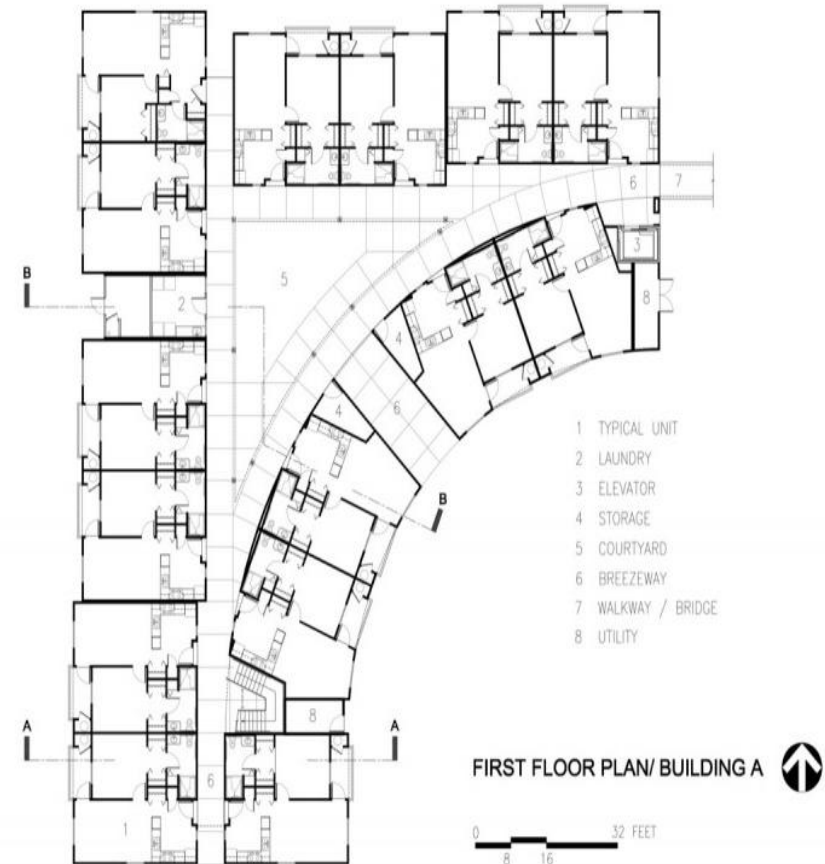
Planta baixa do primeiro pavimento da Casa Grande Senior Apartments.
